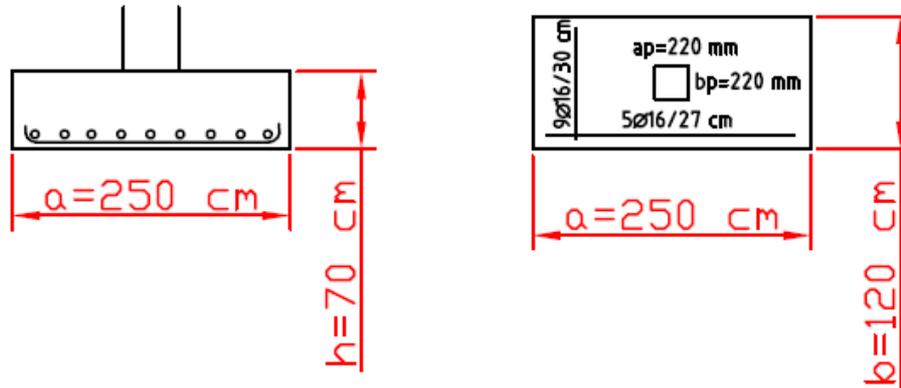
Croquis final de las zapatas de los pilares laterales.
